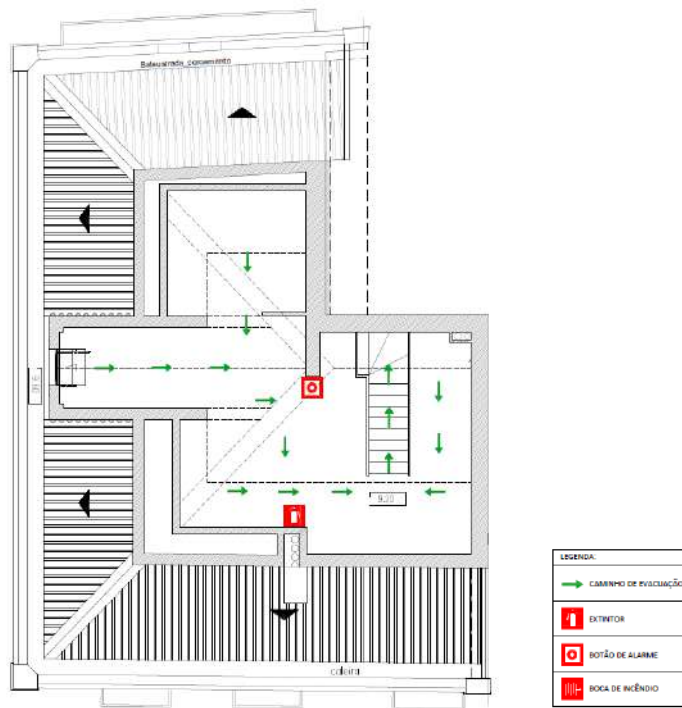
Planta de Incêndio - Piso das Águas-Furtadas
